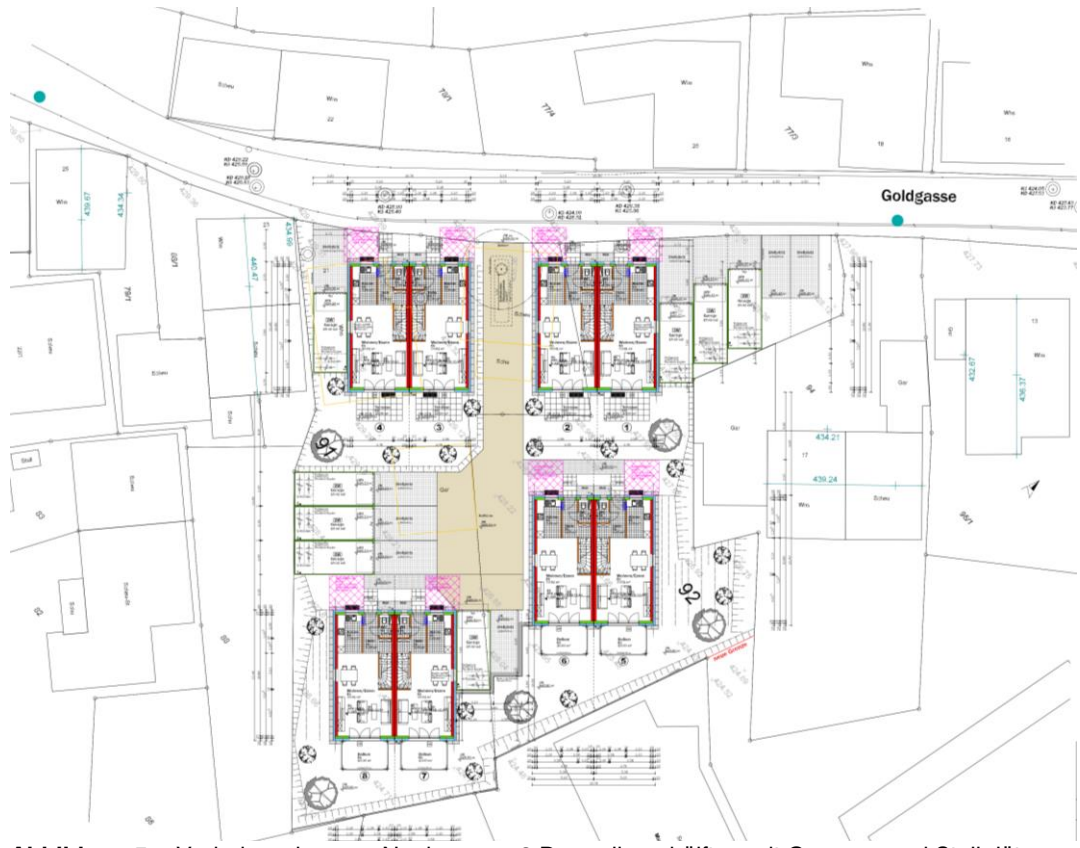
Vorhabenplanung, Neubau von 8 Doppelhaushälften mit Garagen und Stellplätzen, Grundriss Erdgeschoss und Feuerwehrplan, weisenburger bau, 16.12.2020
